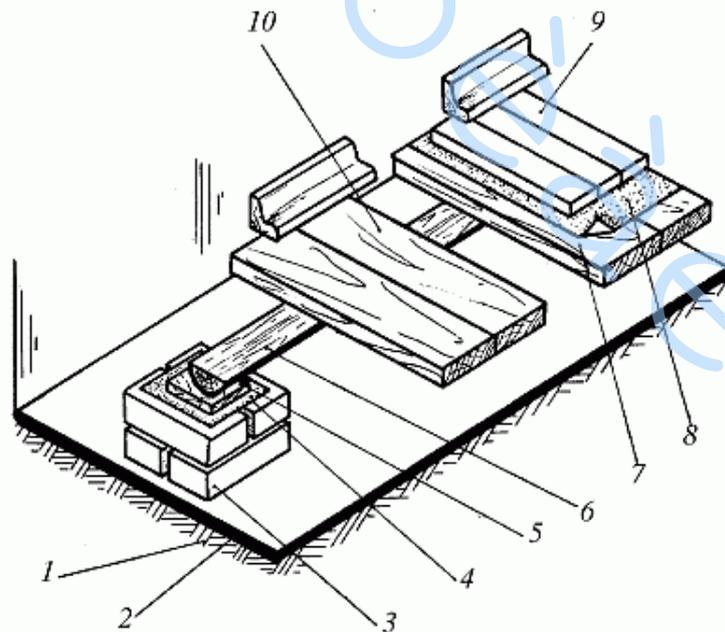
Устройство конструкции пола по грунту при отсутствии техподполья или подвала
